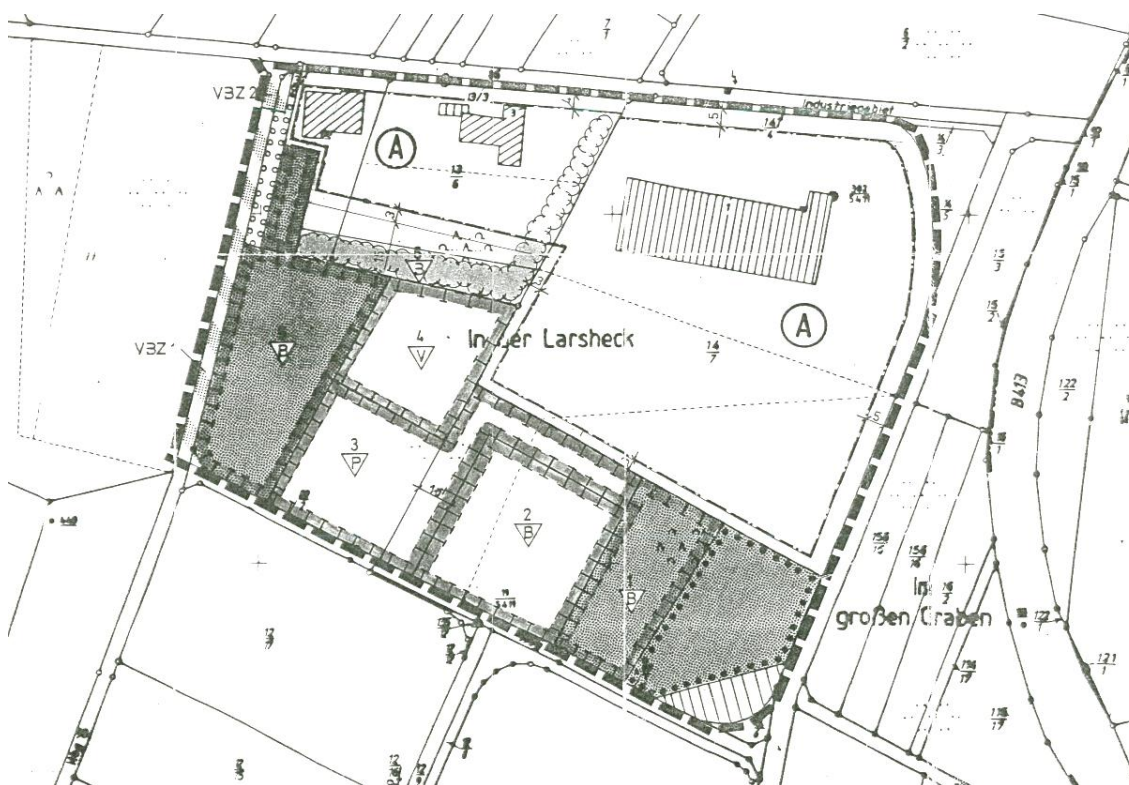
Planzeichnung zum Bebauungsplan „Larsheck, Teil IV“ von 2003
